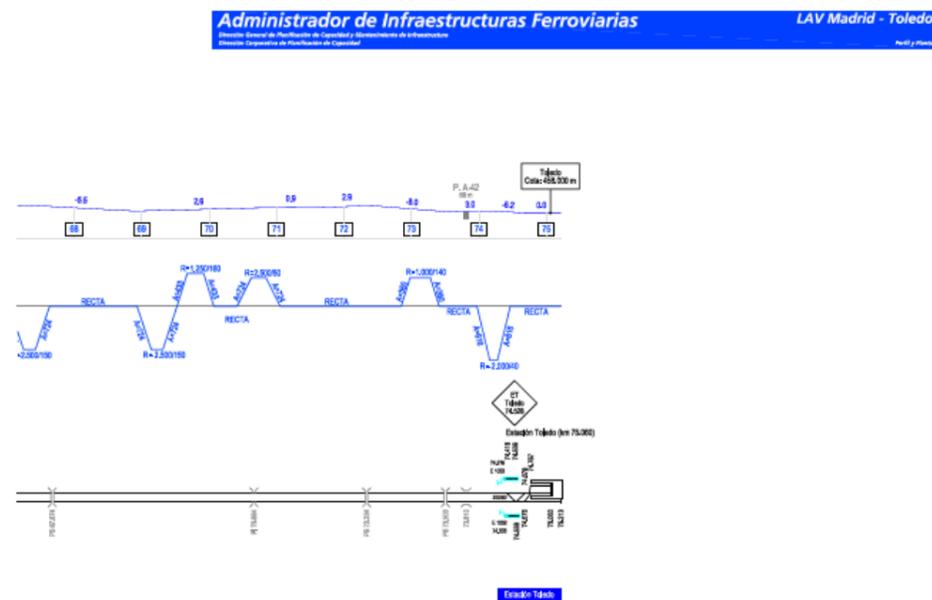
Planta y perfil longitudinal LAV Madrid – Toledo (PP.KK. 68+000 a 75+000). Fuente: ADIF
